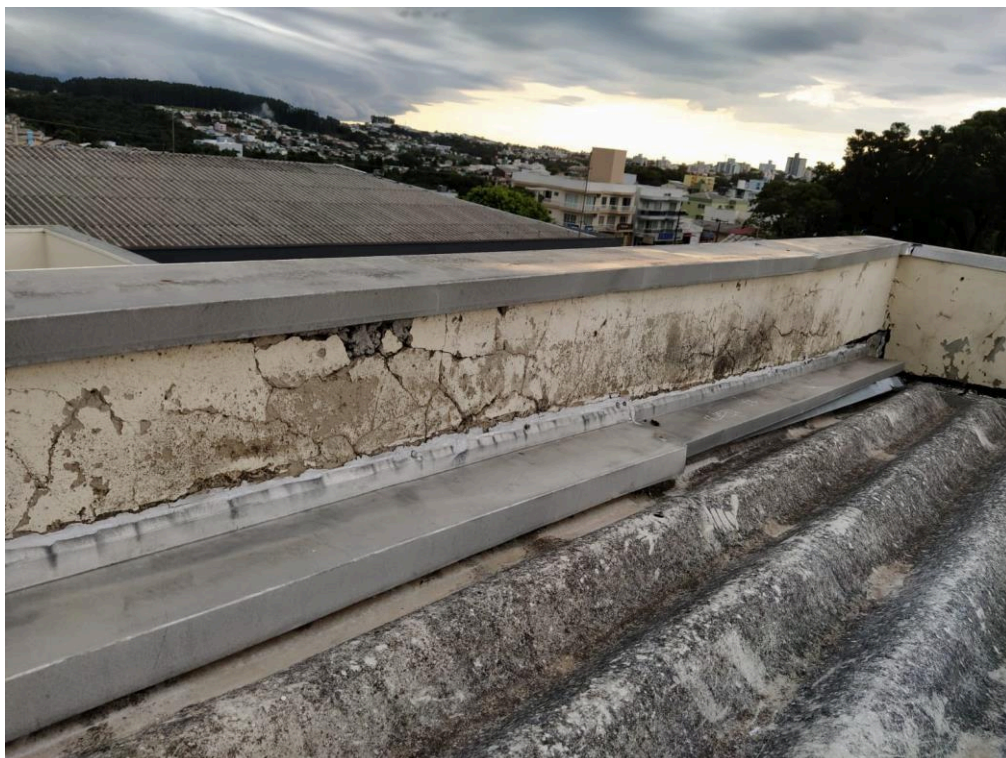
Fissuração do reboco interno e falta de vedação entre a parede e o rufo
